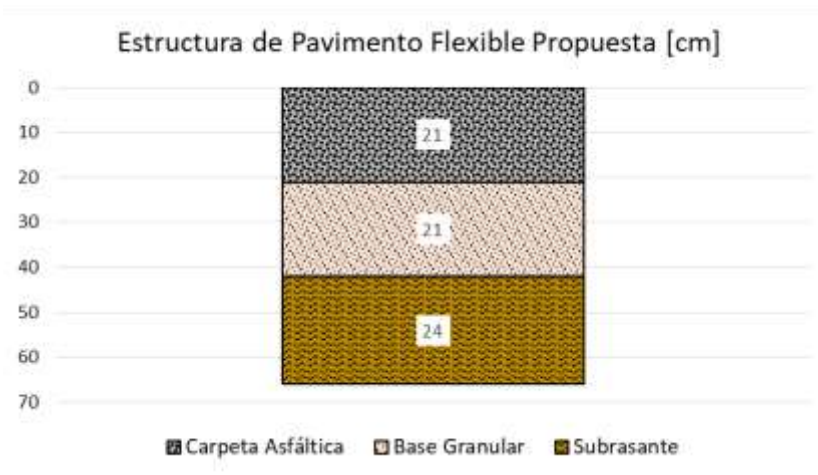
Estructura de Pavimento Flexible Propuesta
